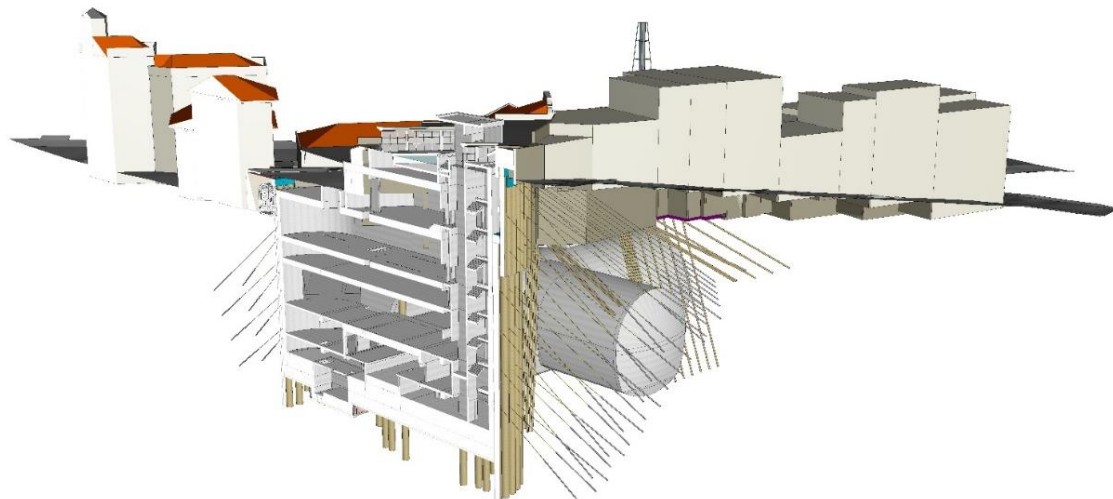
Vista tridimensional da estação – corte pelo poço principal
